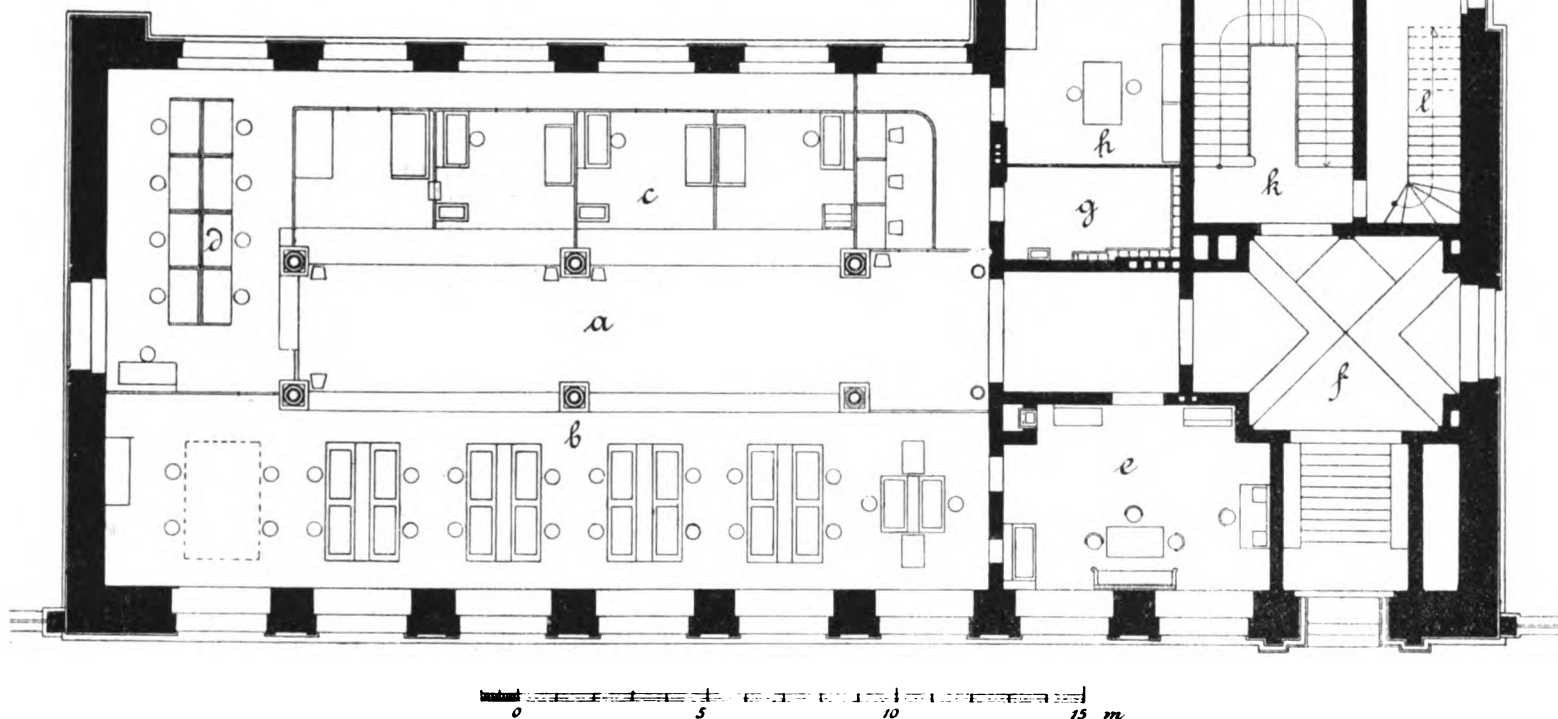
Grundriss des Erdgeschosses. M. 1: 200.
